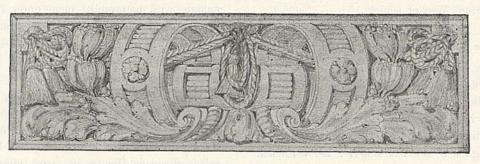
Brüstungsfüllung im Balkontreppenhaus.
